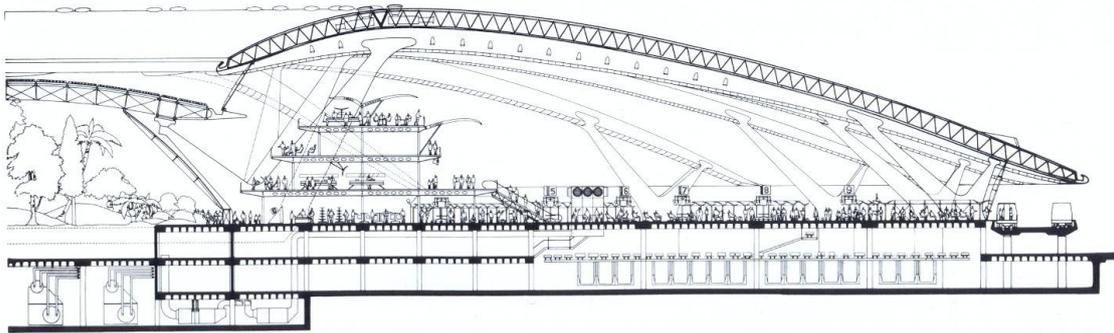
Laje nervurada na parte inferior do terminal proposto por Nicholas Grimshaw para um aeroporto exibido na Bienal de Veneza.
